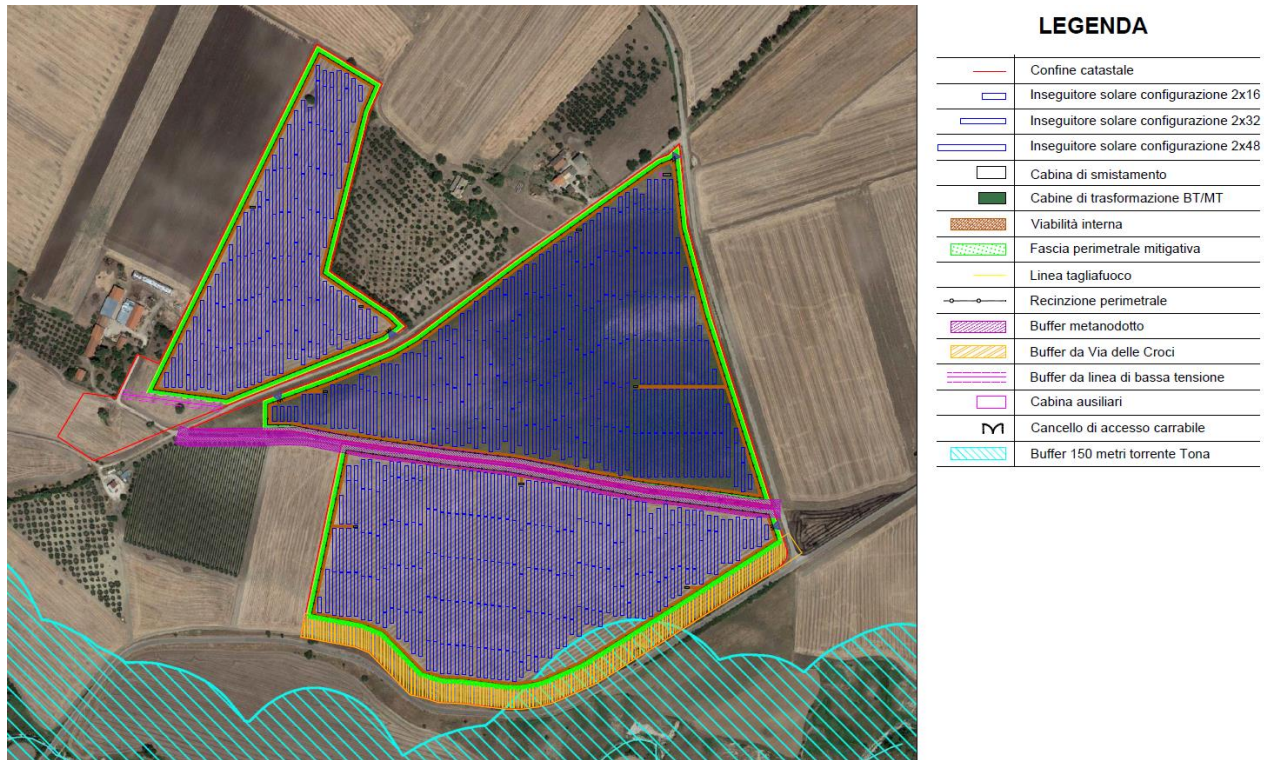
Layout d’impianto con individuazione dei beni individuati dal piano paesaggistico e dalla parte terza del D.lgs. 42/04
